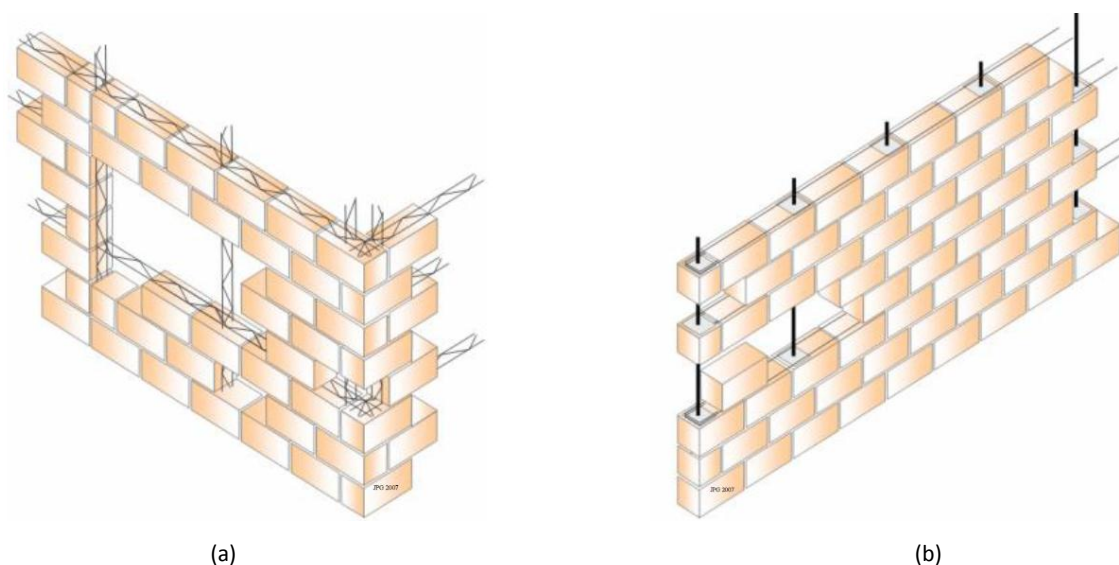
Exemplo de estruturas de alvenaria armada; (a) Alvenaria Armada, com armadura em treliças de aço inoxidável; (b) Alvenaria armada, com armadura ordinária, (reproduzido de Gouveia et al., 2007).
